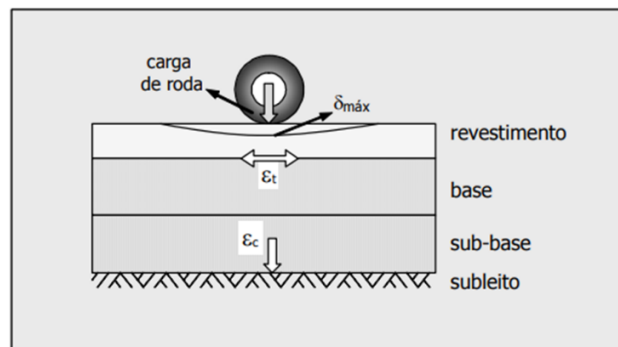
Camadas de um pavimento (Franco, 2007)
